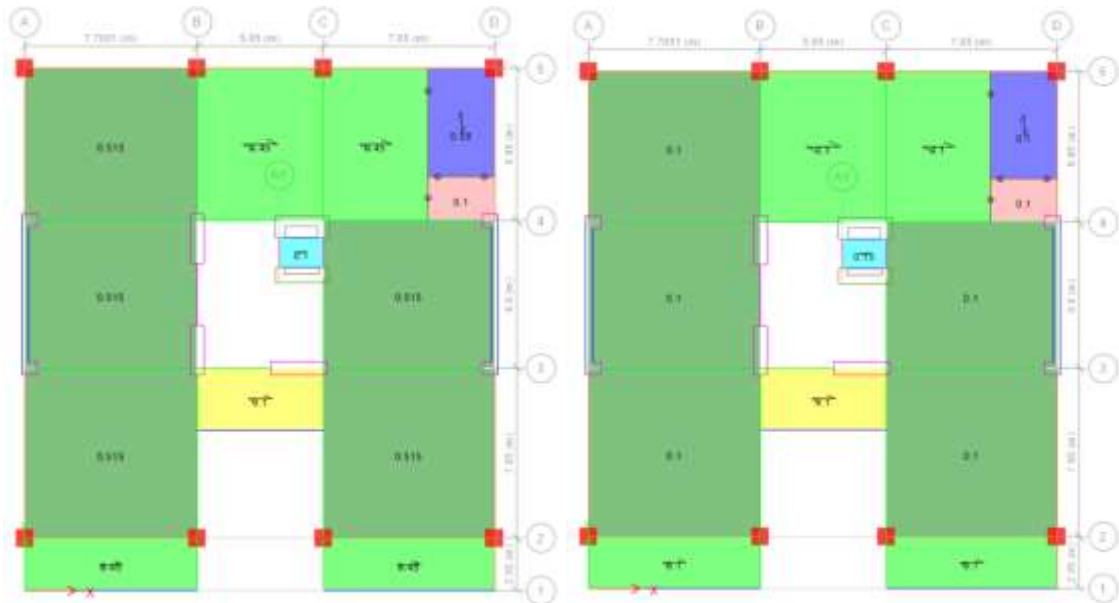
Cargas muertas por tabique en vigas, piso típico.
